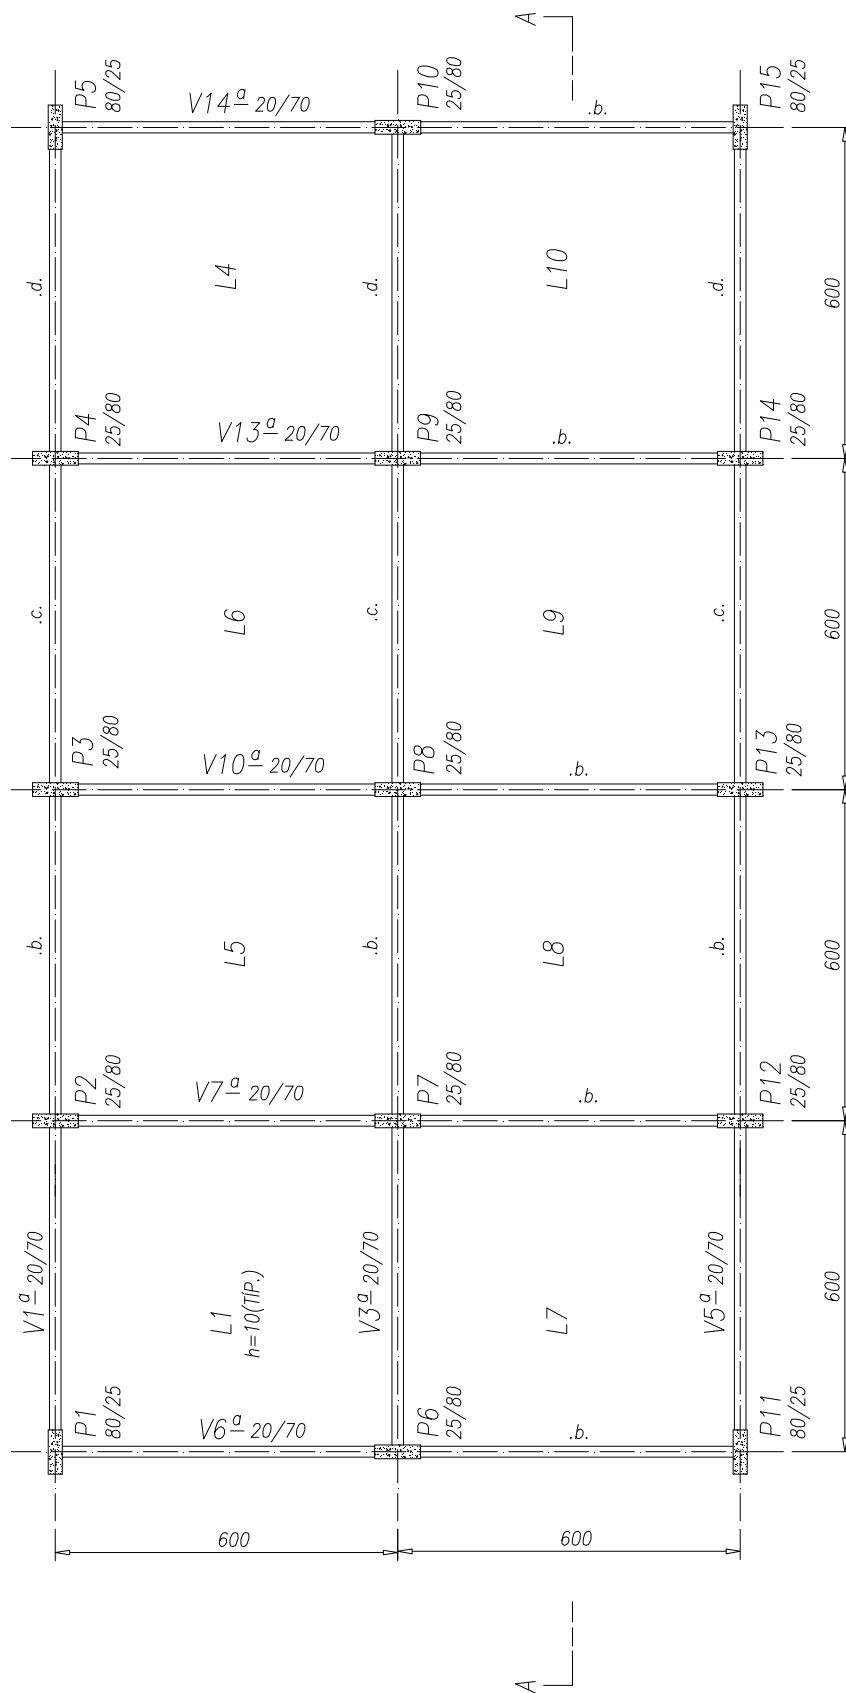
Planta do Andar Tipo (Medidas e Cotas em Centímetro)
